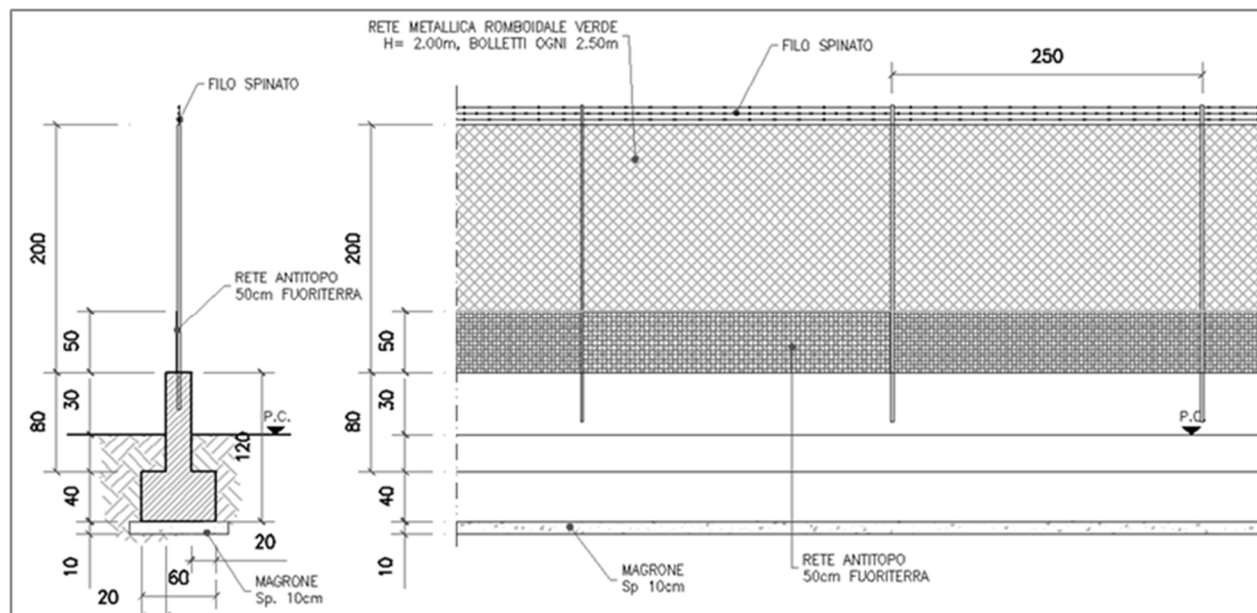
Prospetto e sezione tipologici della recinzione perimetrale
